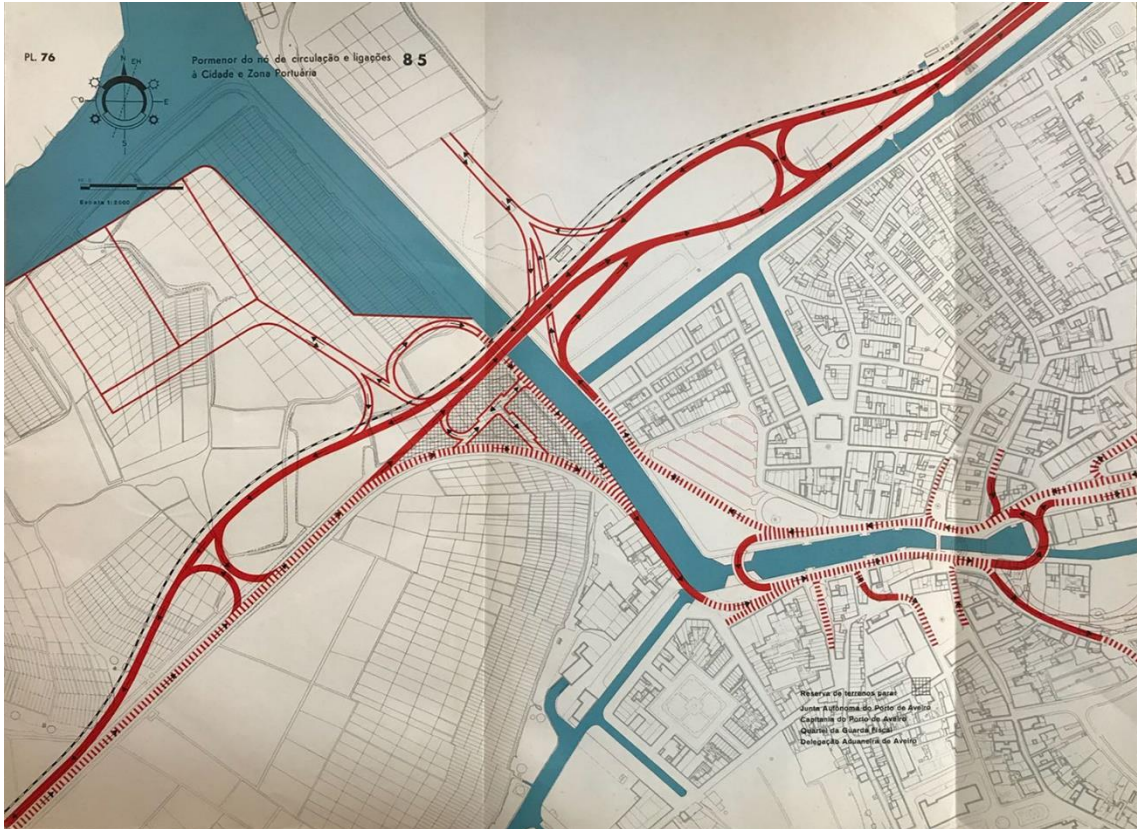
| Plano Pormenor do nó de circulação e ligações à Cidade e Zona Portuária.
